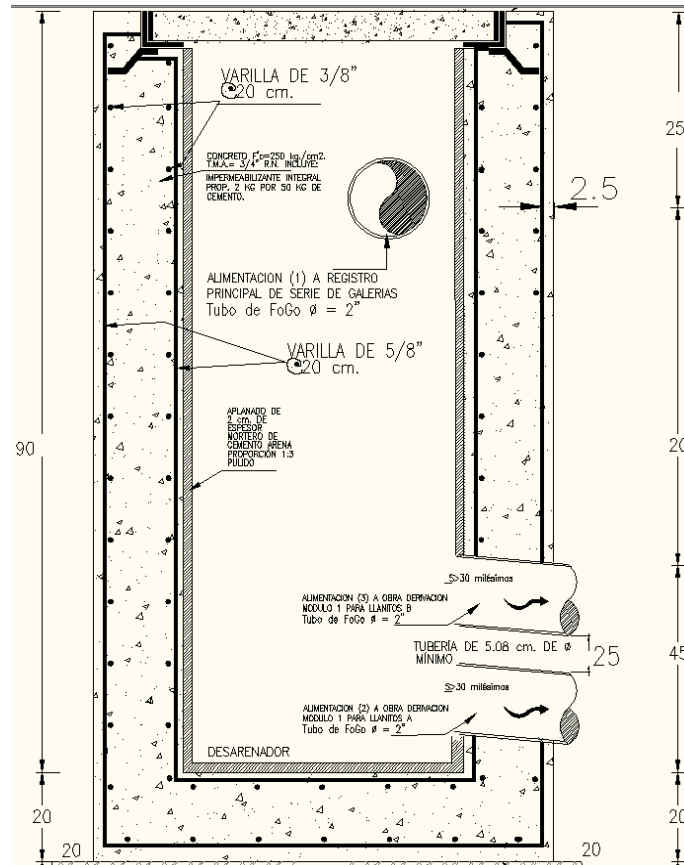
Corte B-B sugerido para desplante de estructura principal de captación.
